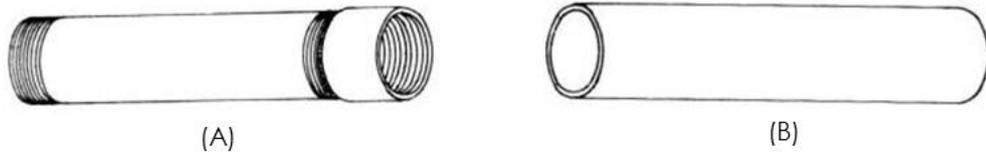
Tubo conduit intermedio o semi pesado (A) y Tubo conduit metálico de pared delgada (rígido ligero y sin rosca en los extremos (B)
